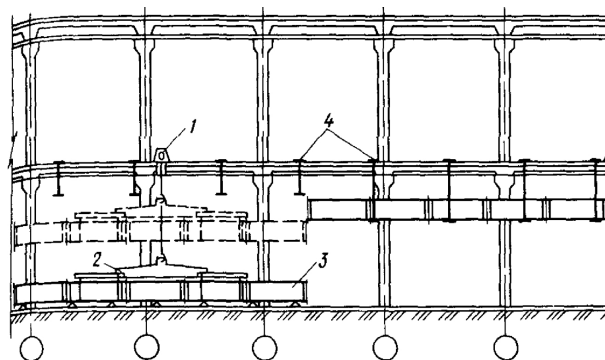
Схема организации рабочей зоны при монтаже горизонтальных воздуховодов в здании: 1 - лебедка; 2 - траверса; 3 - укрупненный узел воздуховода; 4 - подвески
